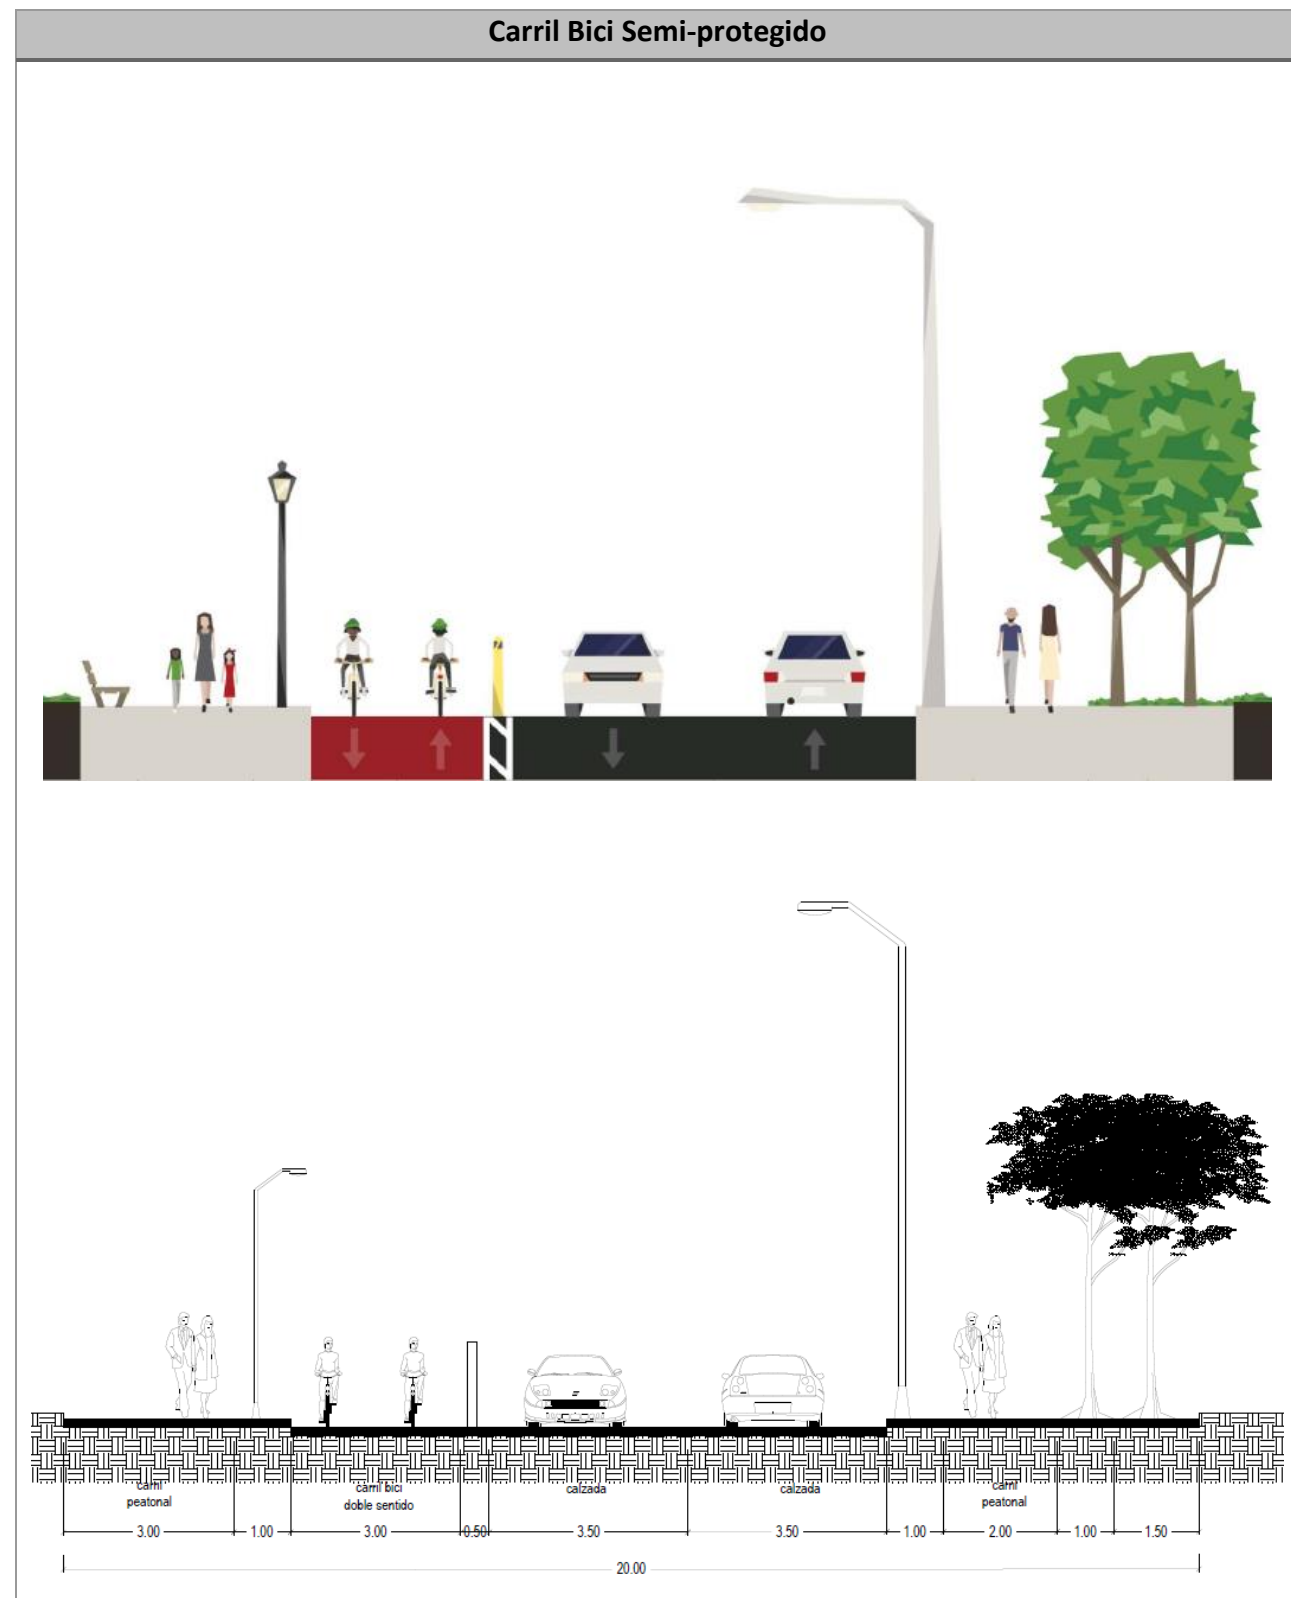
Sección transversal tipo para Carril Bici Semi-protegido. Fuente: Elaboración propia.
